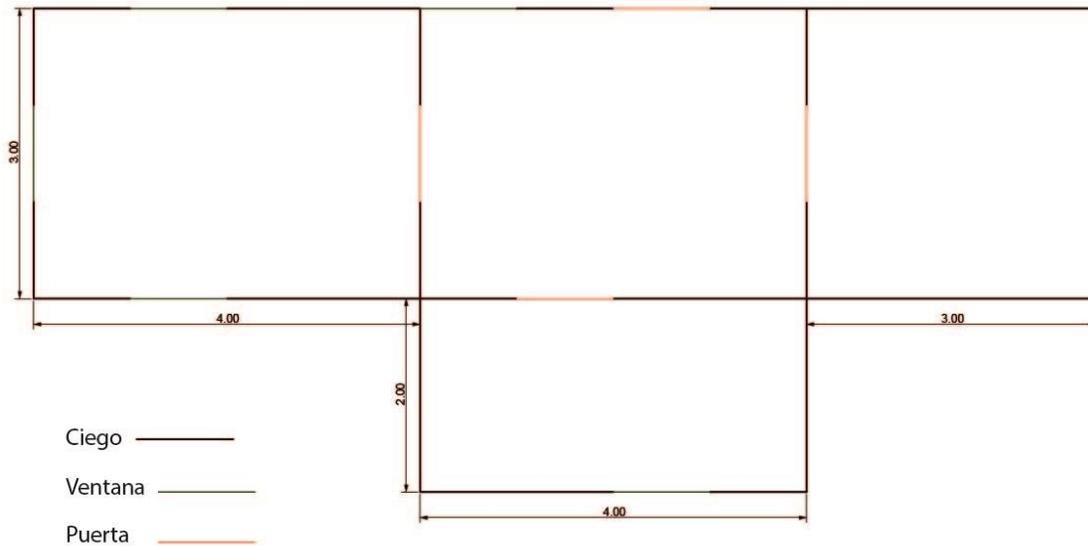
Plano de la vivienda modelo utilizada en el presente trabajo
